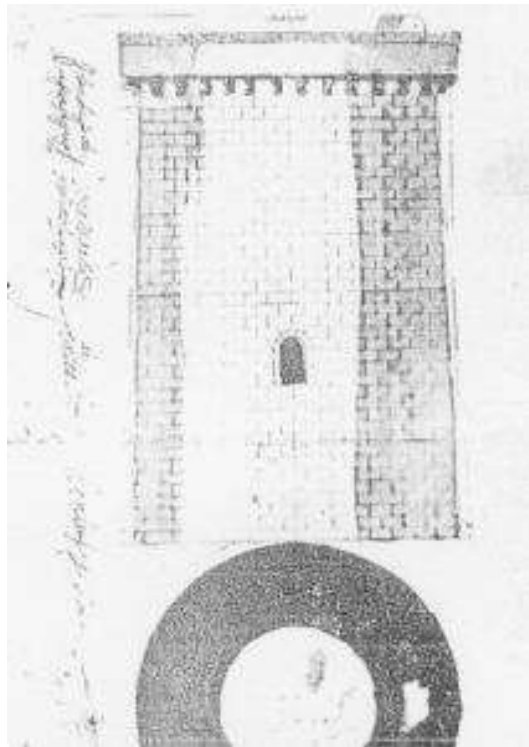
Planta y alzado de la torre defensiva de El Pinatar, (regmurcia.com)
